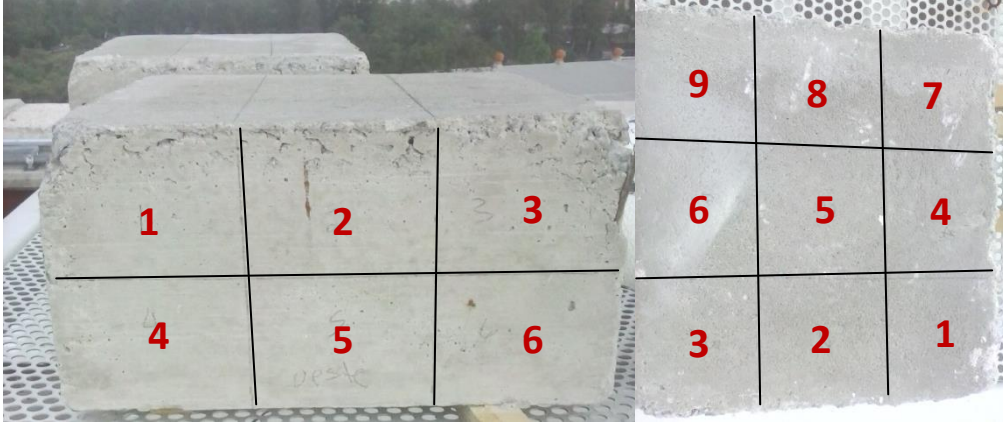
División de las superficies en todas las caras de los bloques. Fuente: Autoría propia, 2015.
